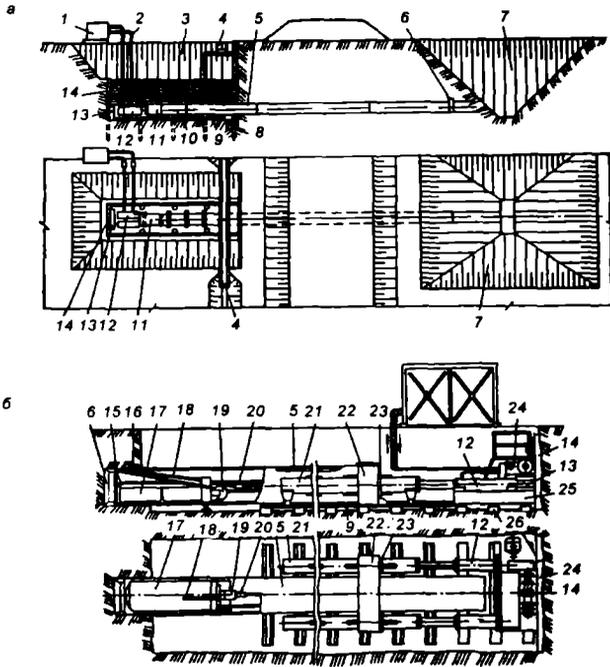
Установки для прокладки трубопроводов (кожухов) методом продавливания:
